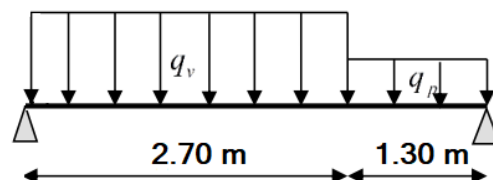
Schéma statique avec chargement de L'escalier (Rdc)
